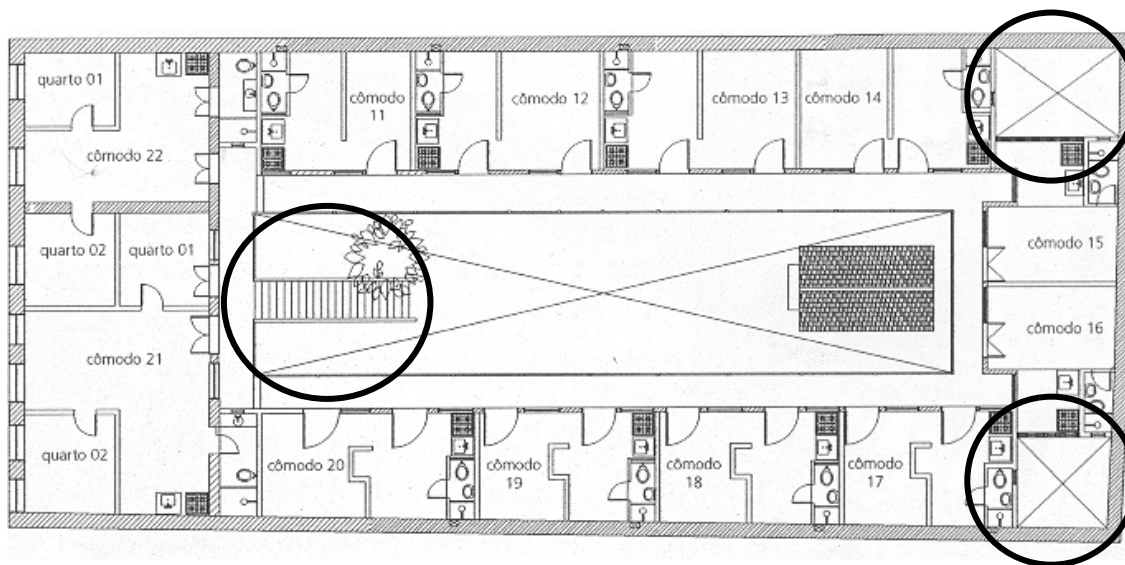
Planta baixa do segundo pavimento, depois da intervenção. Observam-se as alterações na planta, tanto em relação à escada quanto à criação de dois pátios na parte posterior da edificação (SECRETARIA, 2000, p. 35).
